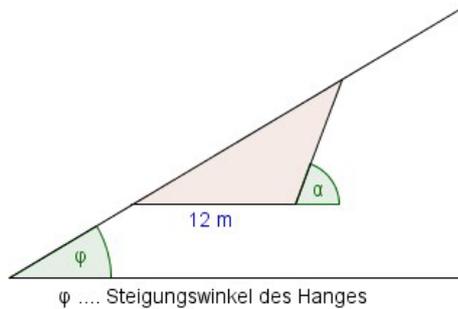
Querschnittsfläche eines Geländeeinschnitts
